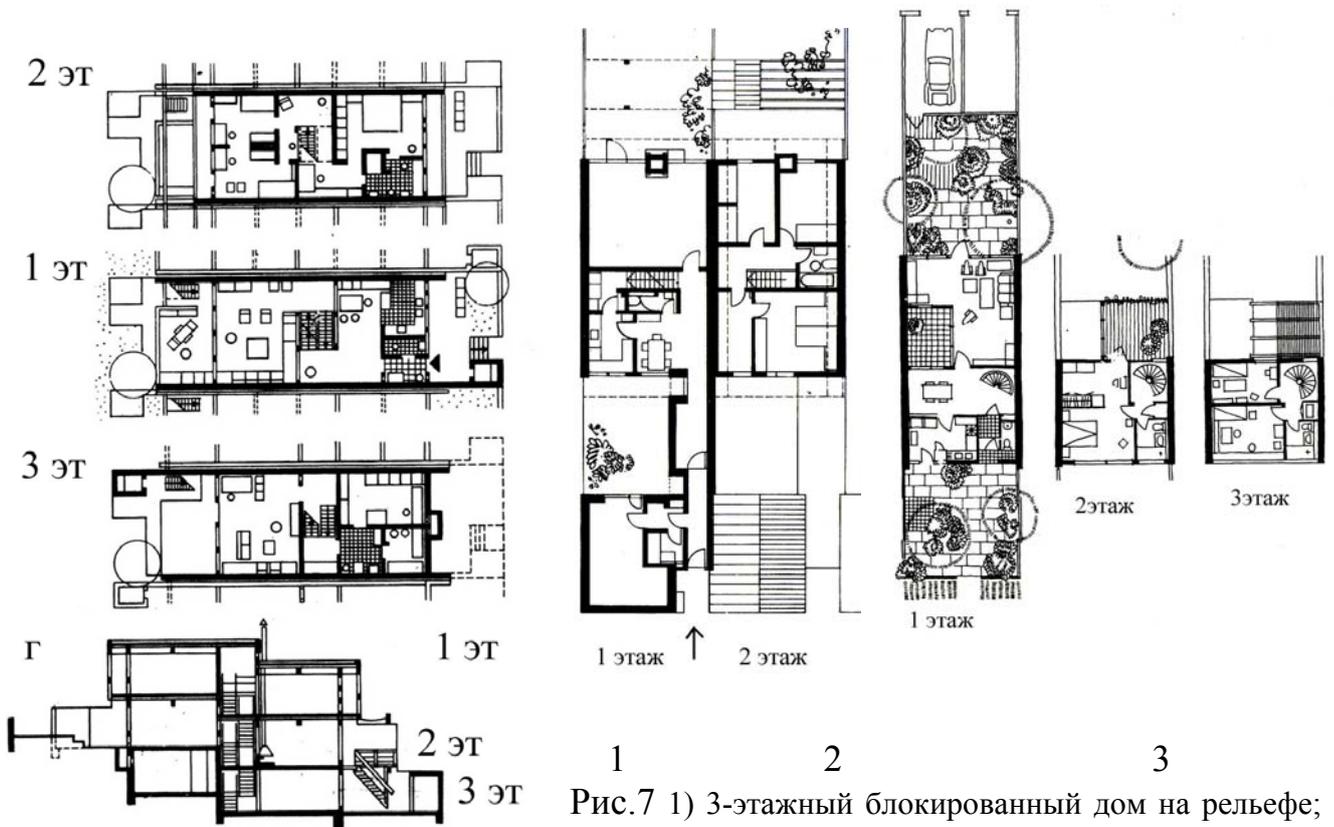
1) 3-этажный блокированный дом на рельефе; 2) 2-этажный блокированный дом с гаражом перед домом; 3) 3-этажный блокированный дом с внутренним двориком на первом этаже.
